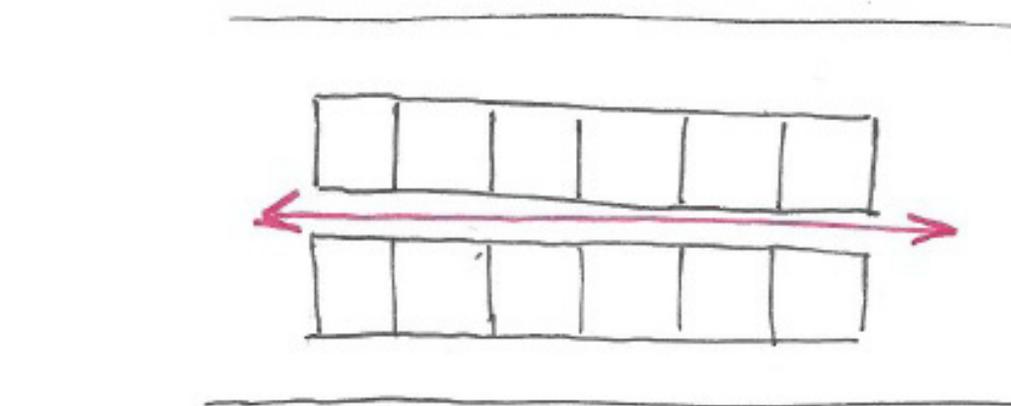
Planta baixa esquemática - Corredores extensos fadigam e geram isolamento.
